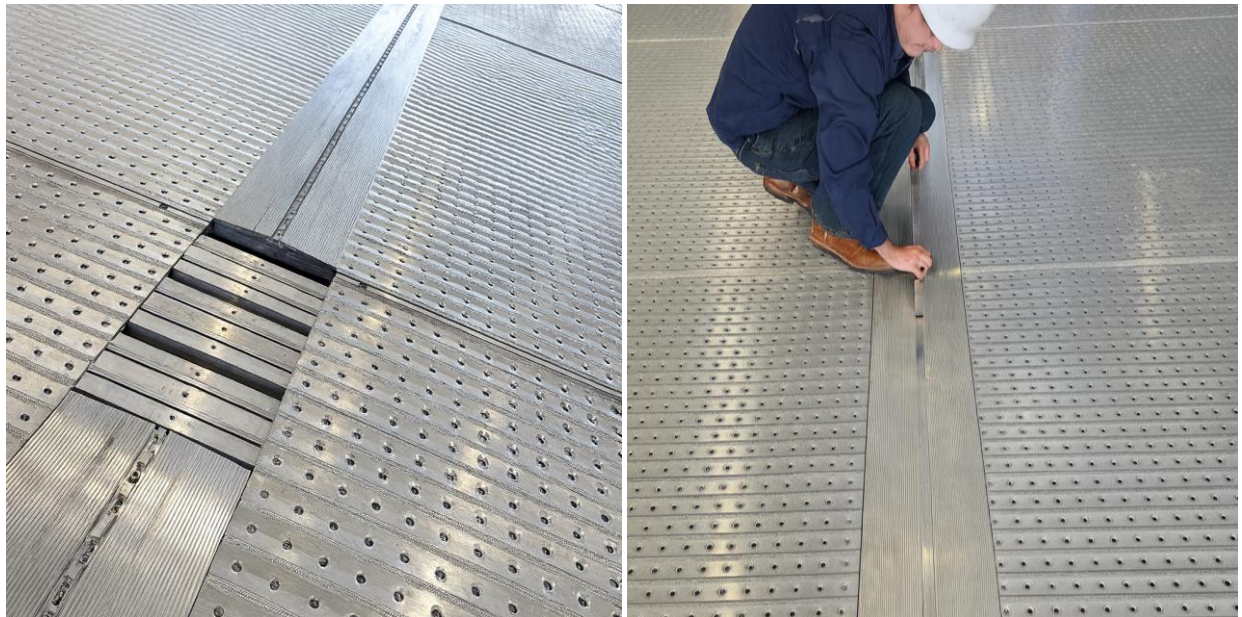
Tapas de zanja parcialmente instaladas con algunas vigas de soporte aún expuestas (Izquierda).
